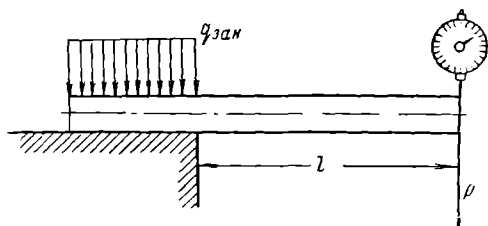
Схема испытания консольных балок, нагруженных на опоре
